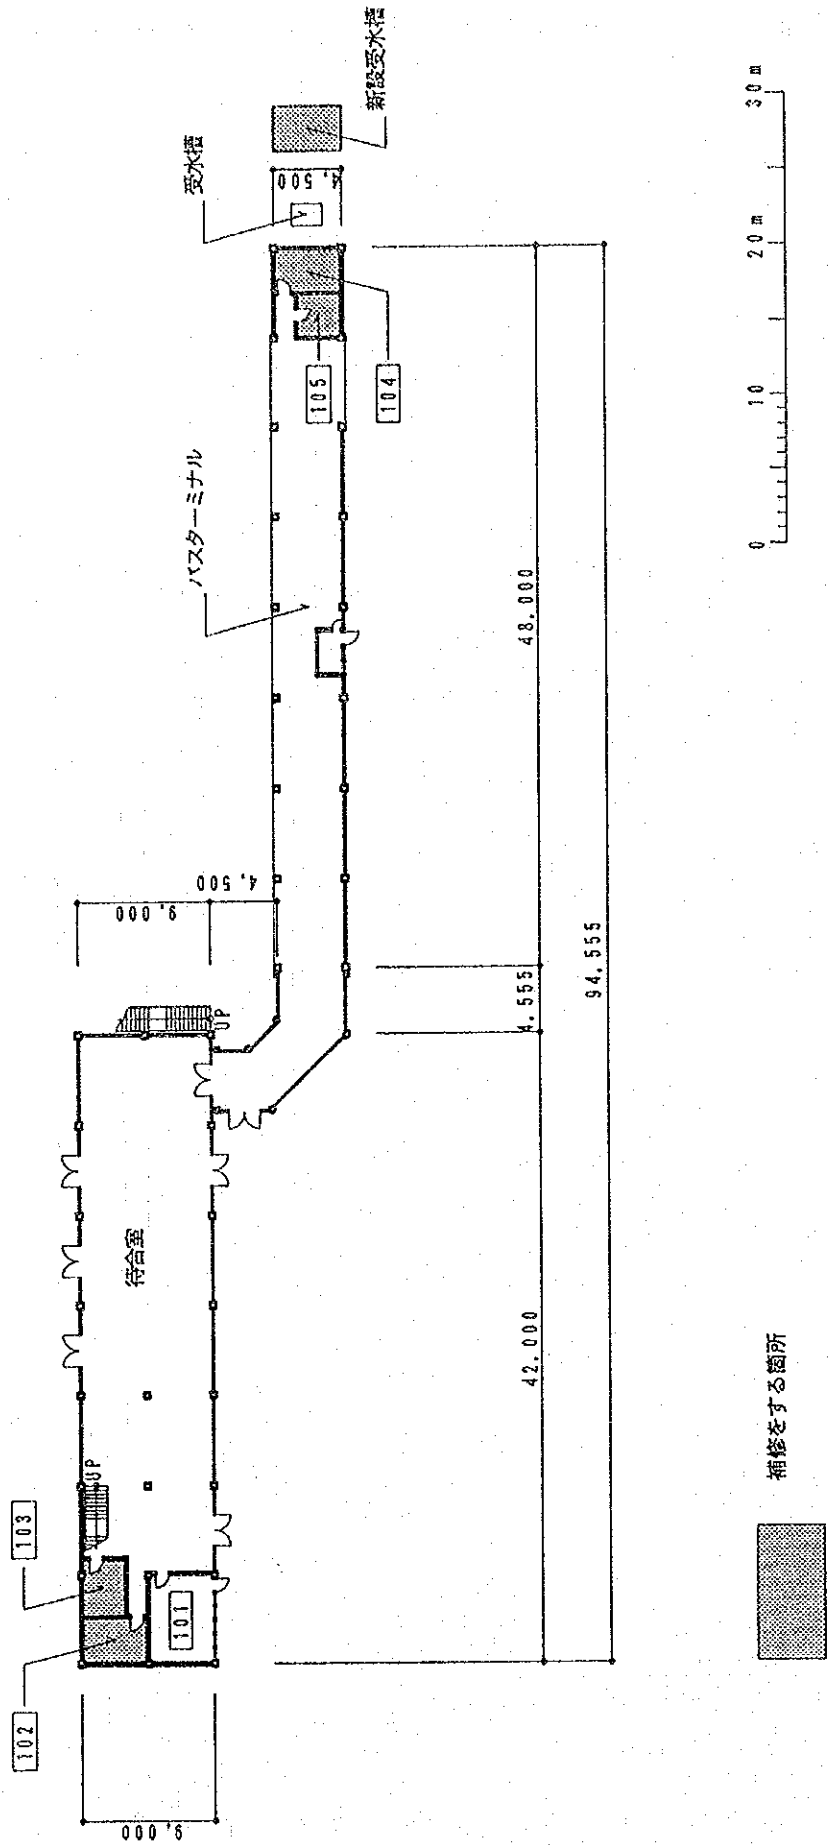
ムリファアヌア港 フェリーターミナルビル1階平面図
